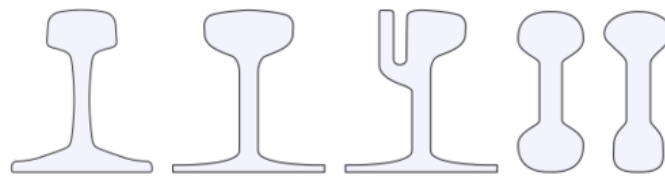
Sección transversal de los carriles más utilizados en la infraestructura ferroviaria
